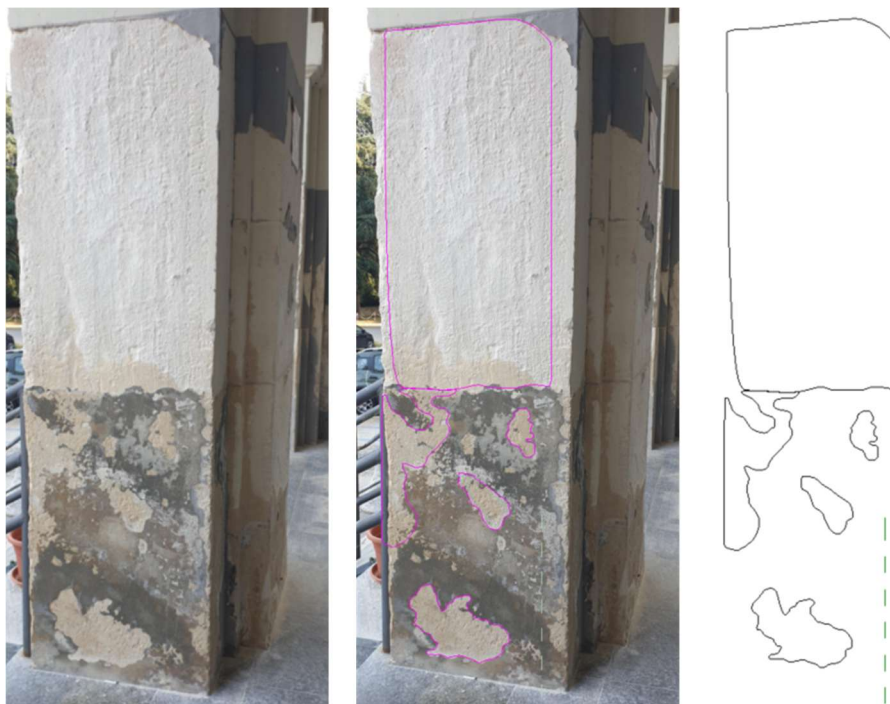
Individuazione del degrado “distacco” nel pilastro in esame (Fonte: elaborato dall'autore)
